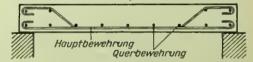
Bewehrung einer Stahlbetonplatte
